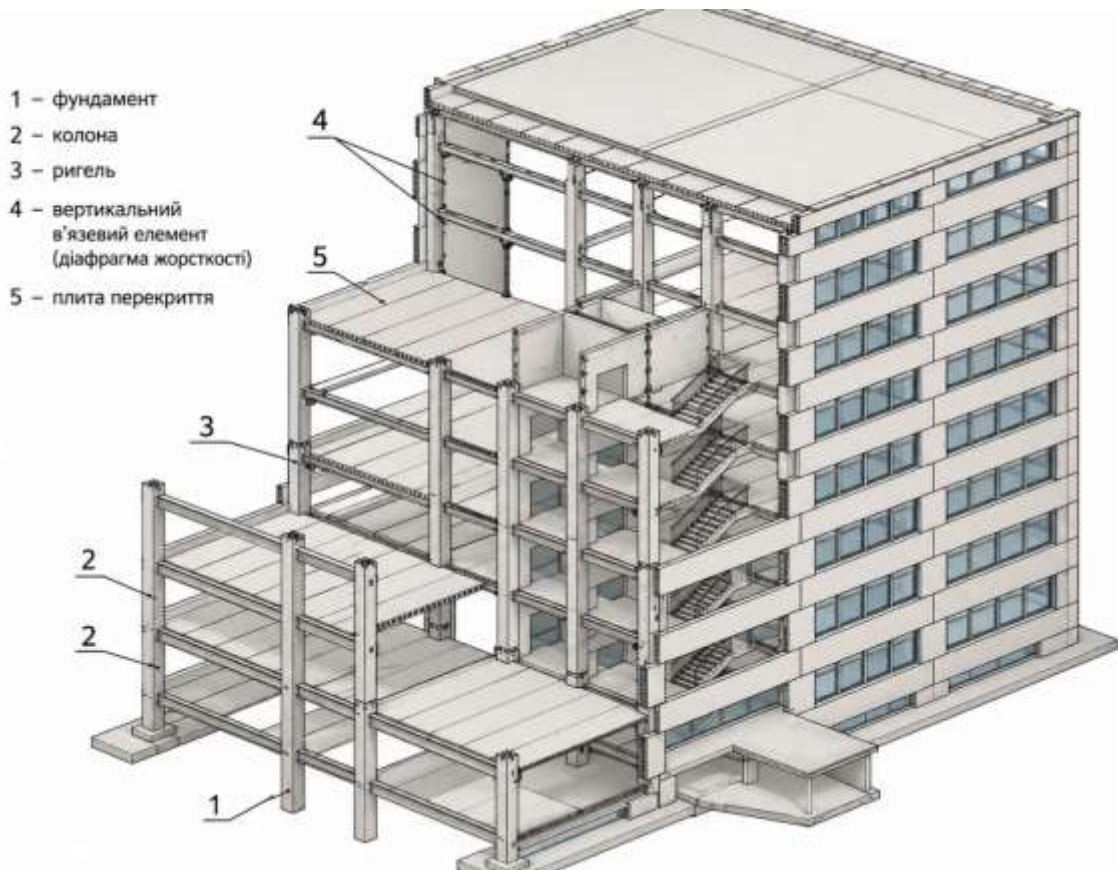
Конструктивна схема типової багатоповерхової промислової будівлі: 1 – міжповерхові перекриття; 2, 3 – залізобетонні колони; 4 – вертикальні діафрагми жорсткості; 5 – навісні стінові панелі.
